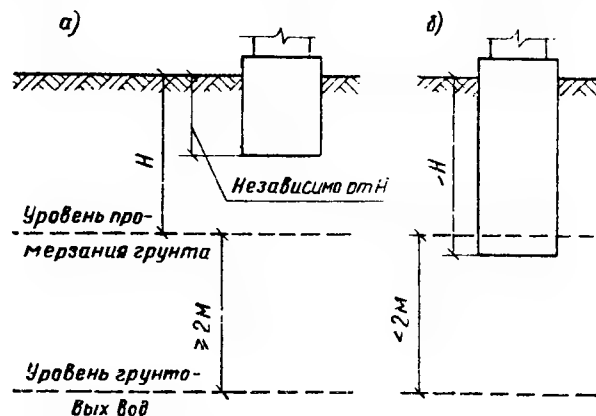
Выбор глубины заложения фундаментов а — при глубоком уровне грунтовых вод; б — при высоком уровне грунтовых вод
